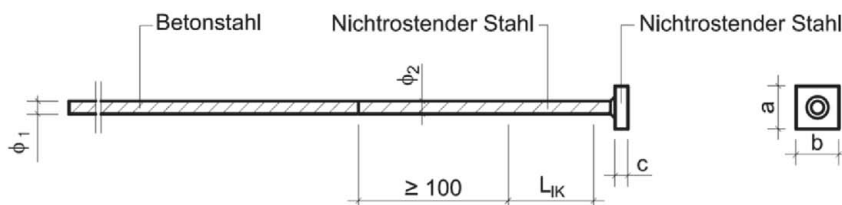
Druckelement aus Stahl mit angeschweißter Druckplatte und angeschweißtem Betonstahl
